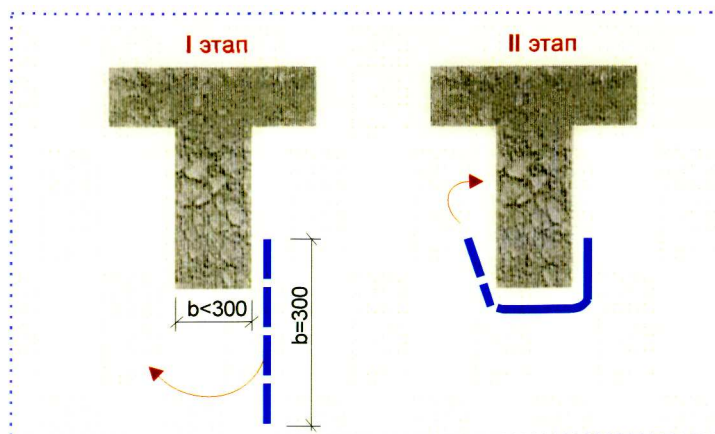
Усиление балочных конструкций. Схема наклейки лент на ребро
